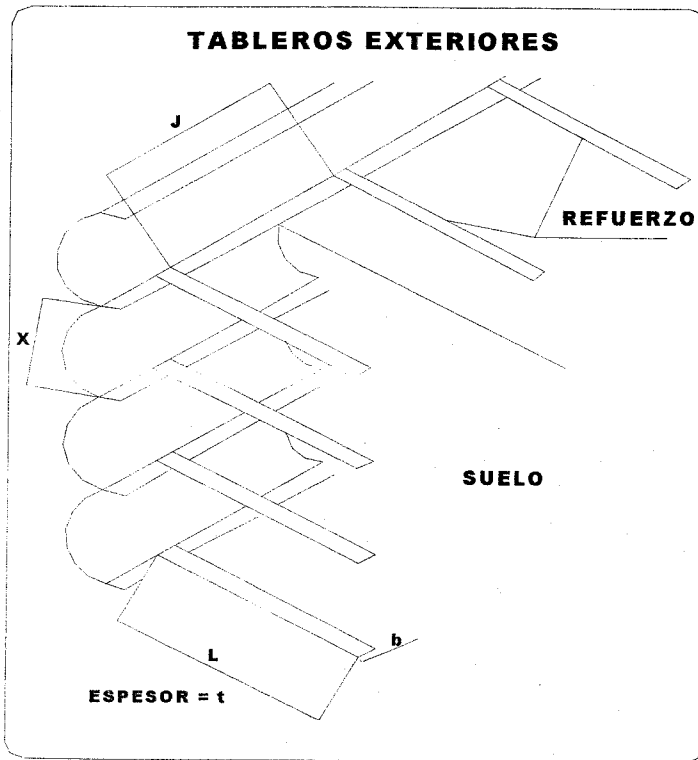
MURO DE TIERRA ARMADA (VIDAL)
